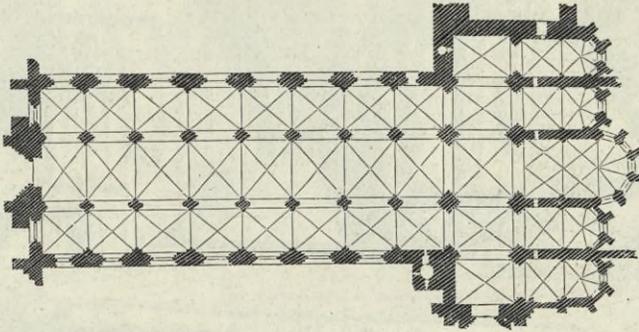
Grundriß der Klosterkirche zu Batalha.
